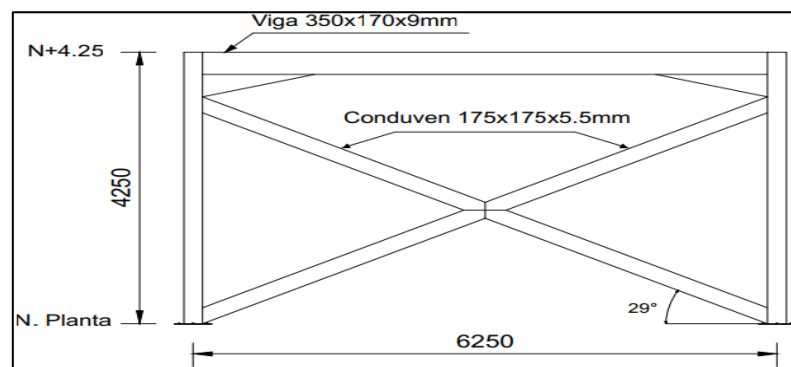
Pórtico entre N. planta y N+4.25, con arriostamiento lateral en “X”, viga 350x170x9mm, y luz de 6.25m
